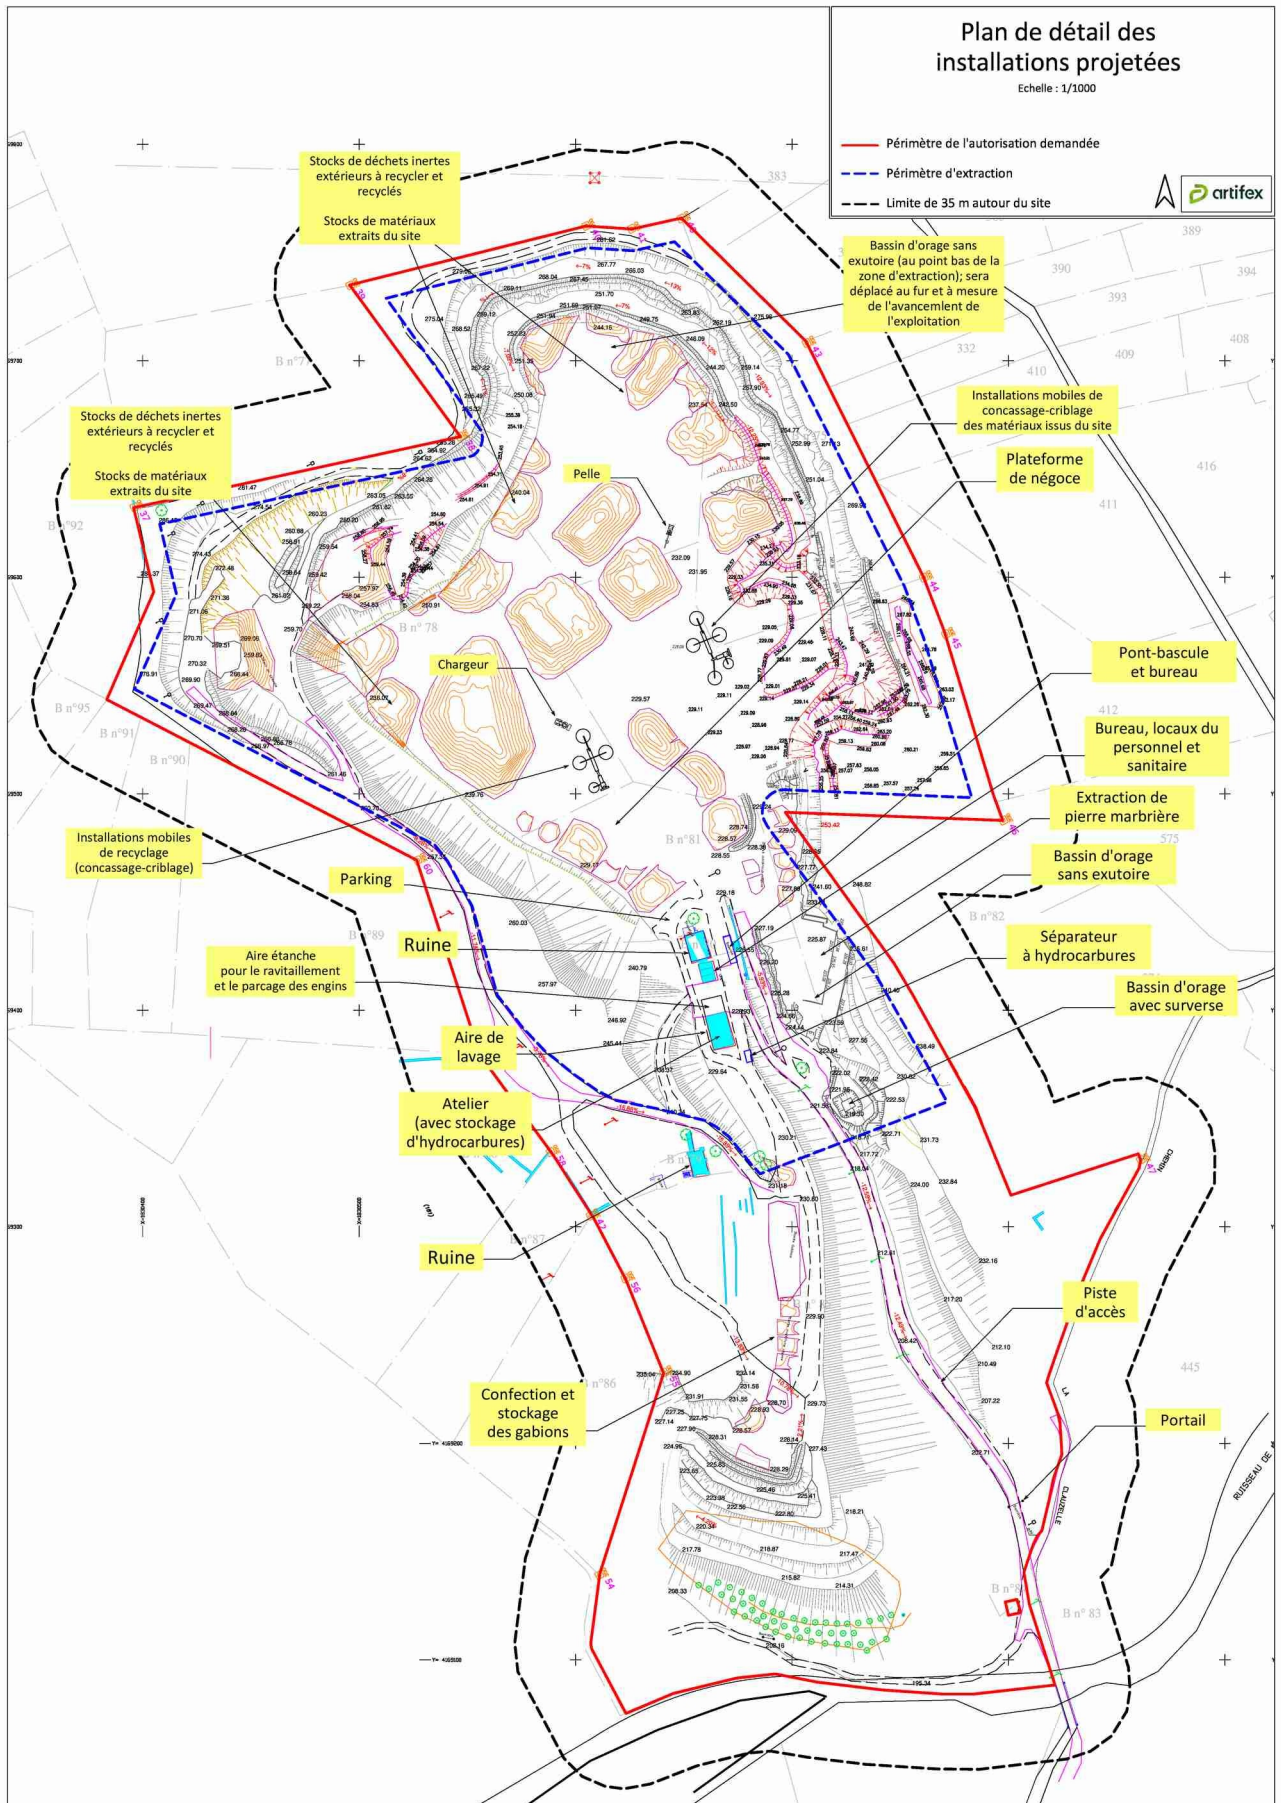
Plan de détail des installations projetées (source : cartes et plans du dossier d'étude d'impact).
